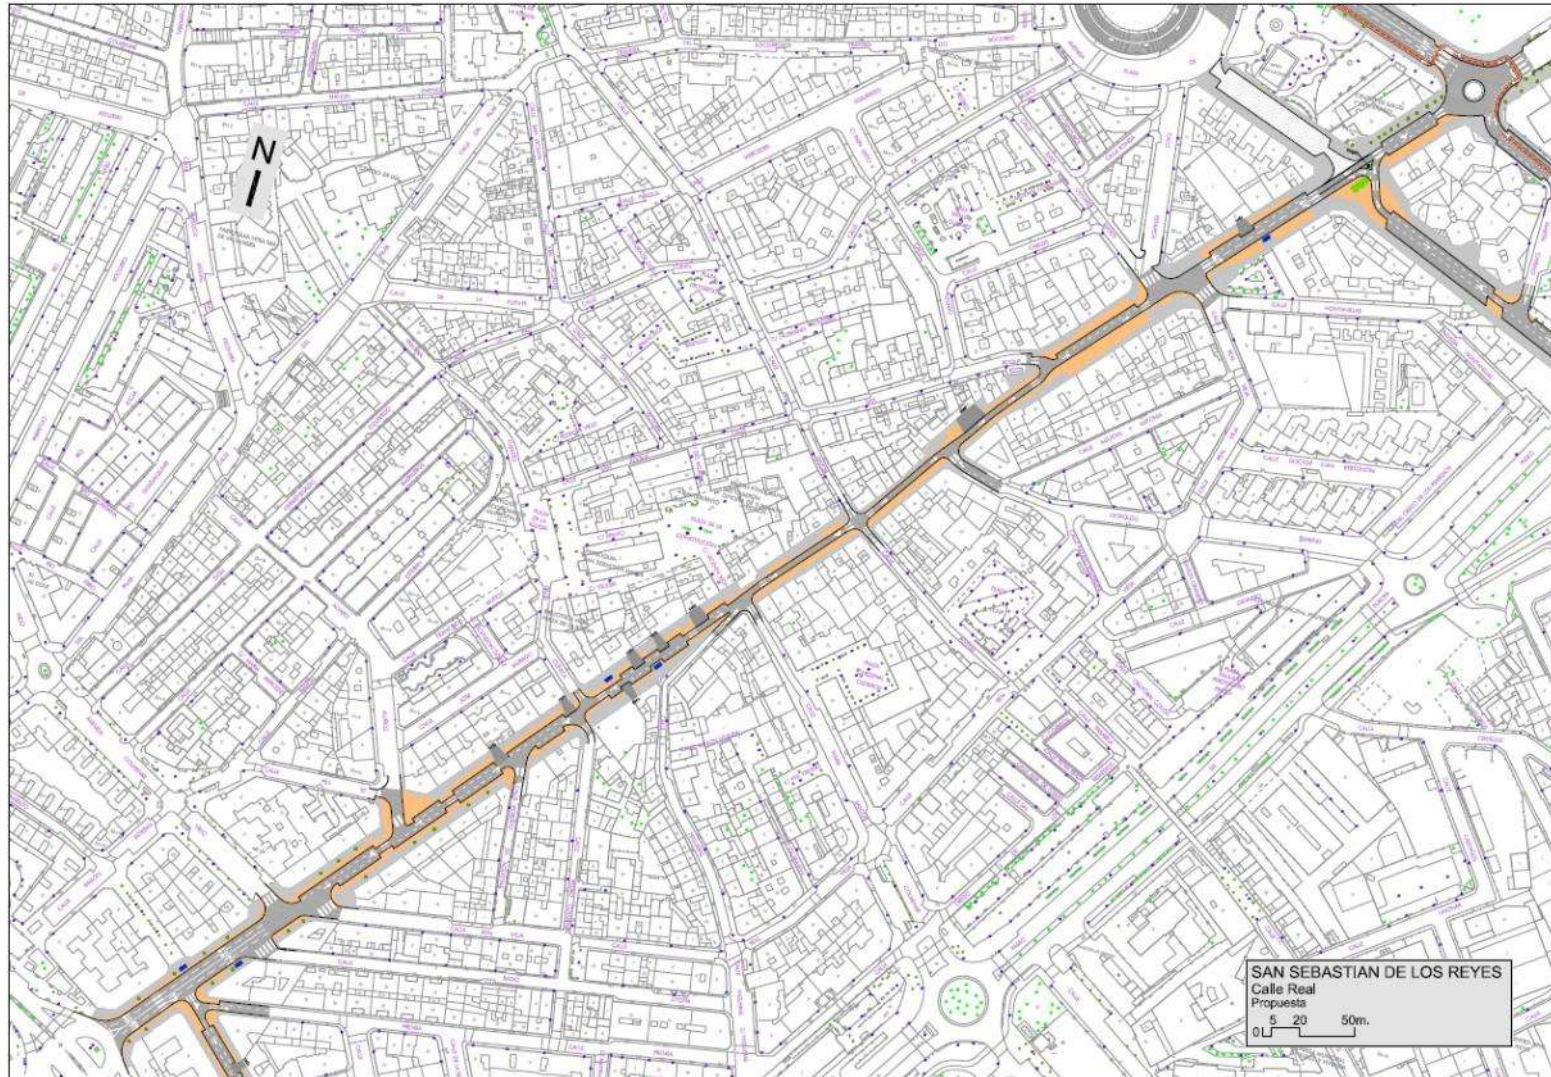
Planta propuesta para Calle Real. Fuente: DOYMO.
